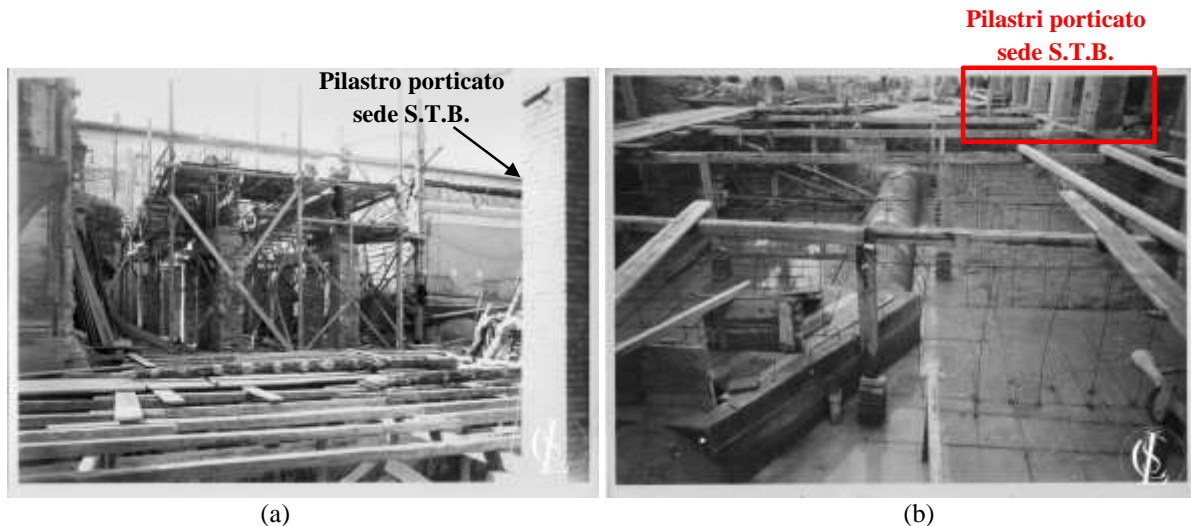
(a), (b) Lavori di costruzione delle strutture di fondazione della torre posta in adiacenza al palazzo sede S.T.B.
